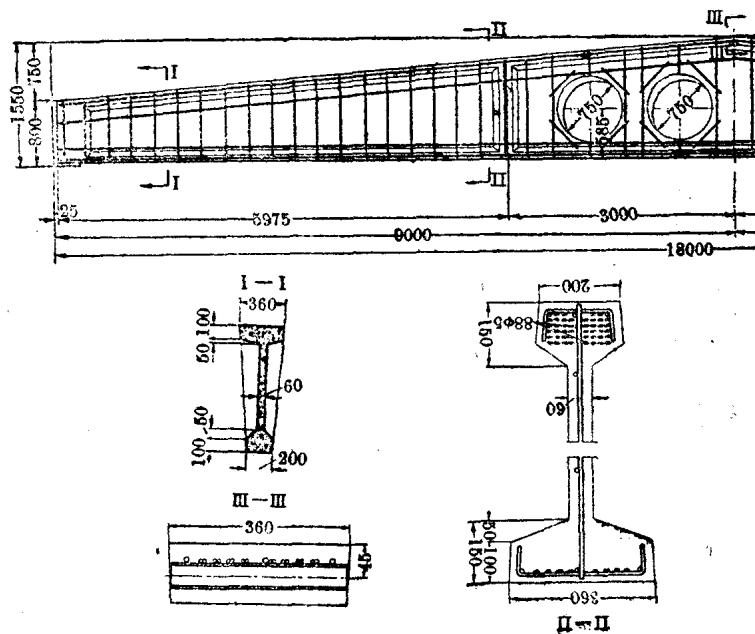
跨度为 18 米的鋼弦混凝土屋面梁
